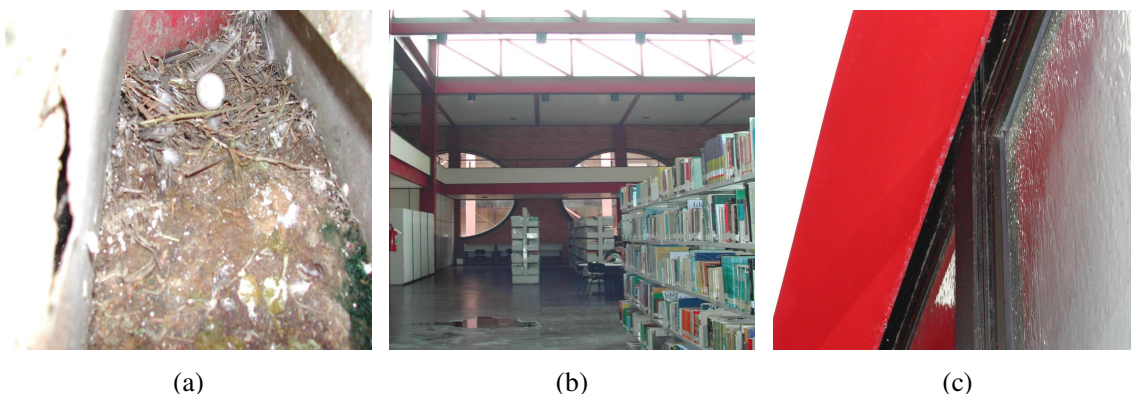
Calha suja (a) infiltração na cobertura da biblioteca (b) e no contato da estrutura-vidro (c)
